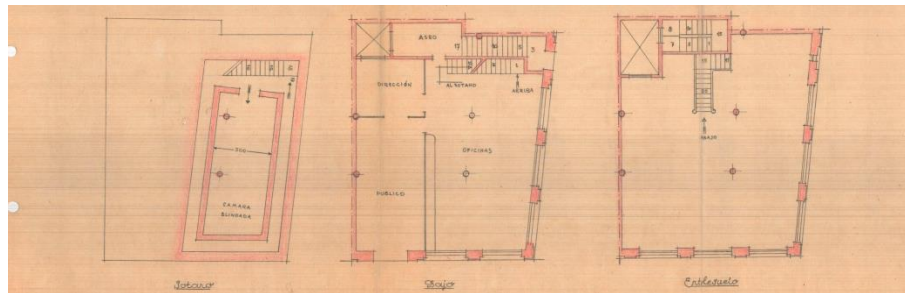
Lámina que incluye la planta sótano, planta baja y planta del entresuelo
